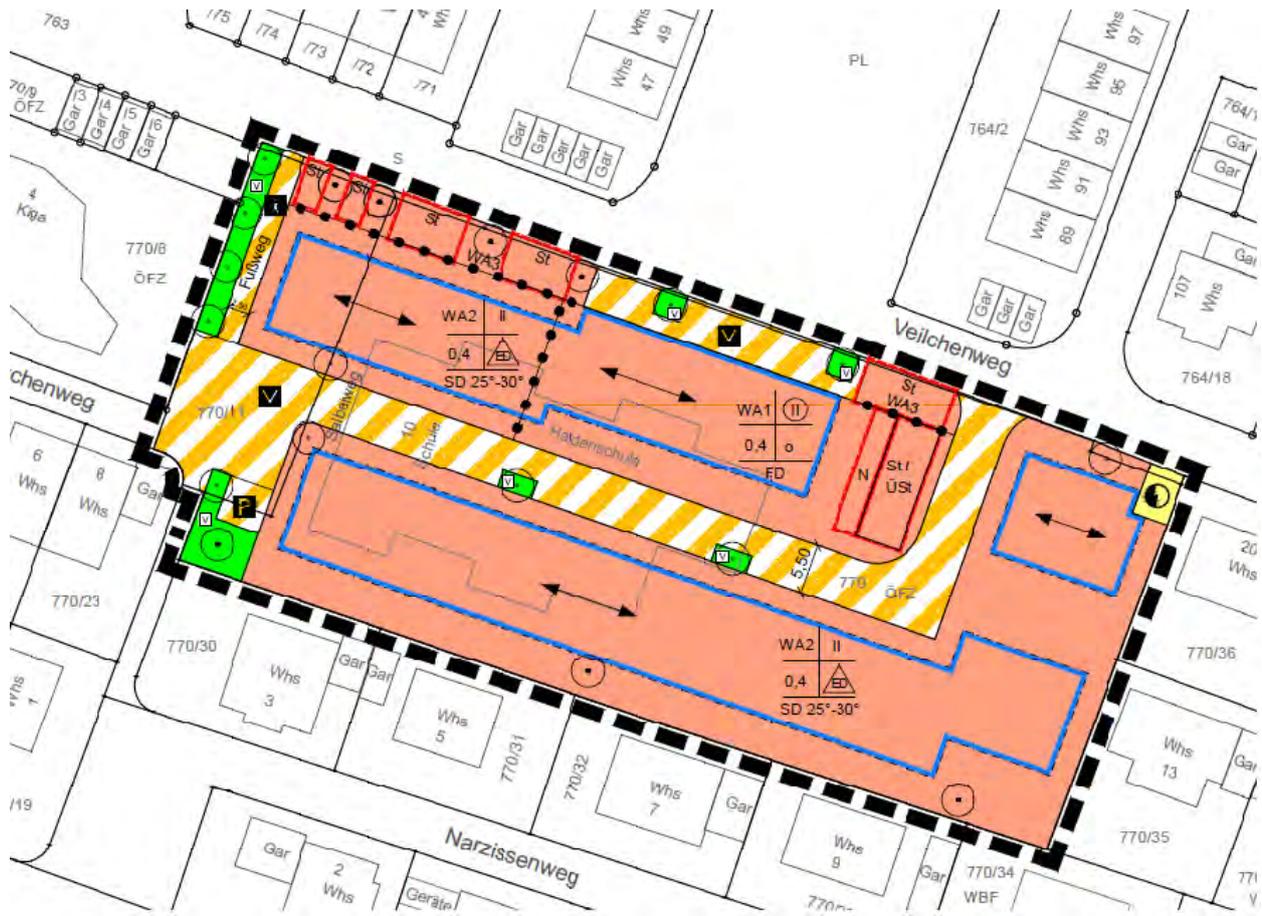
Planauszug zur 3. Änderung des Bebauungsplans Ötlinger Halde I in Kirchheim unter Teck (Quelle: Stadtverwaltung Kirchheim unter Teck, Stand 02.10.2019).
